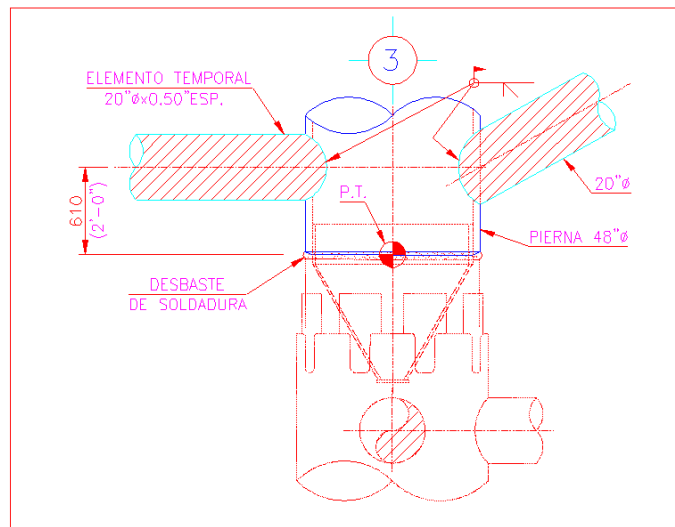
CORTE DE LA SOLDADURA EN LA UNIÓN COLUMNA-PILETE
